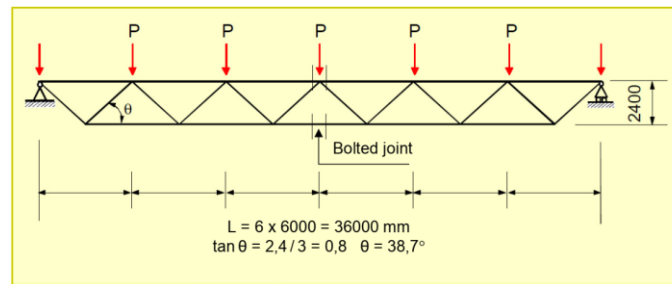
ESTRUTURA TRELIÇADA, ADAPTADO DE [11]
